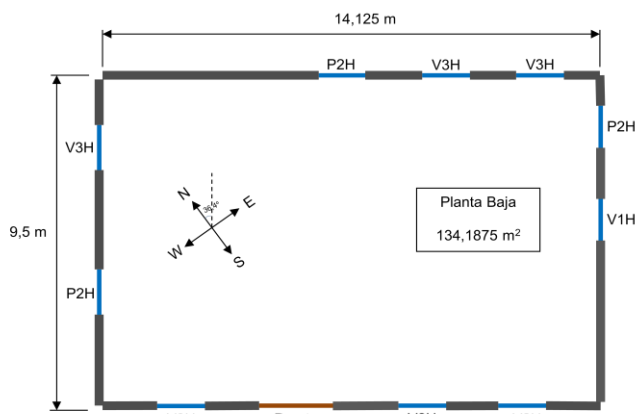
Esquema de la planta de la planta baja (V1H: Ventana 1 Hoja; V2H: Ventana 2 Hojas; V3H: Ventana 3 Hojas; P2H: Puerta 2 Hojas) (dimensiones exteriores)
